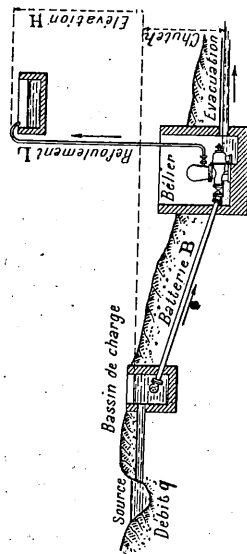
Schéma d'installation d'un béliet hydraulique.
